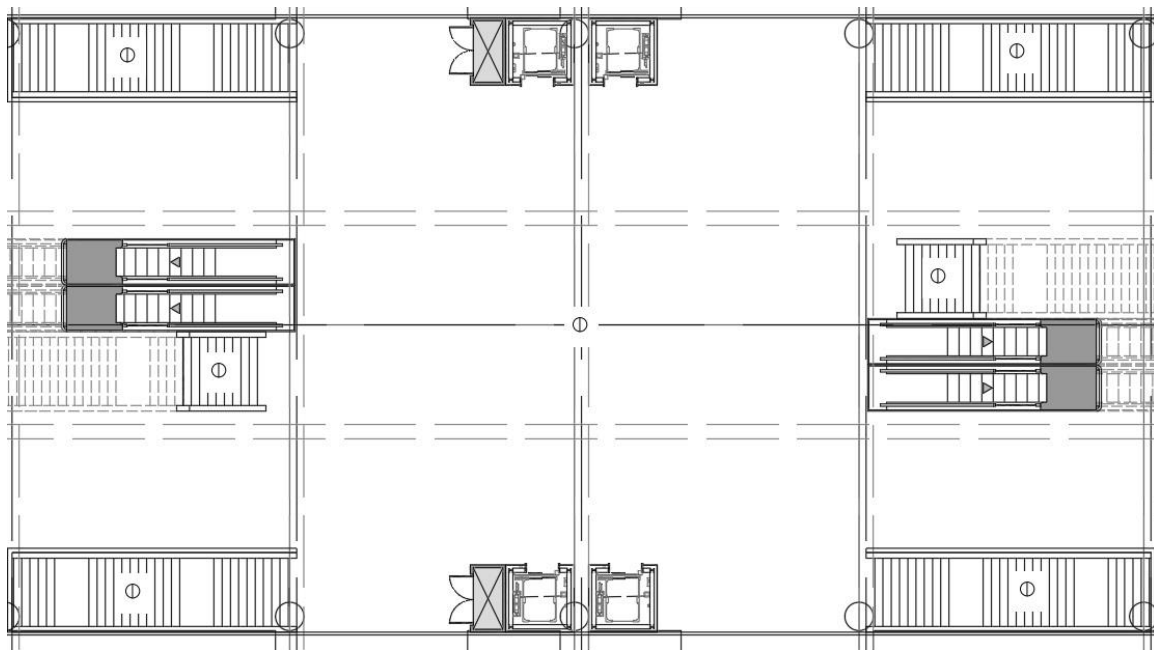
Sistema Megafonía ascensores Planta 3 Estación típica
